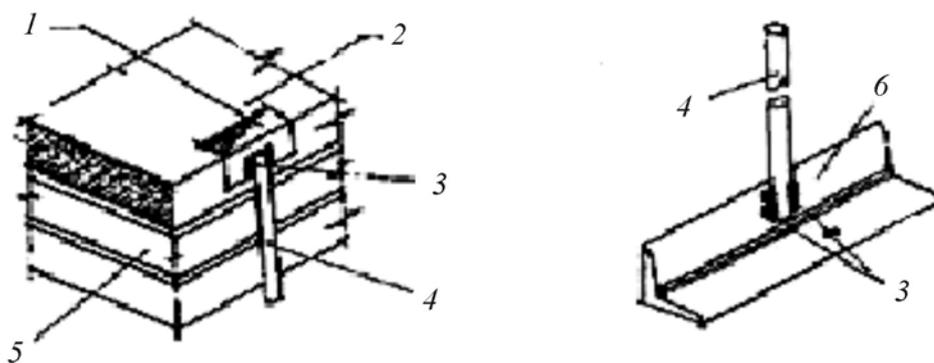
Крепление карнизных плит: 1 — закладная деталь карнизной плиты; 2 — карнизная плита; 3 — сварные швы; 4 — анкер $\text{Ø}18\text{Ат}$; 5 — кирпичная кладка; 6 — стальной угол $L76 \times 8 \text{ мм}$
